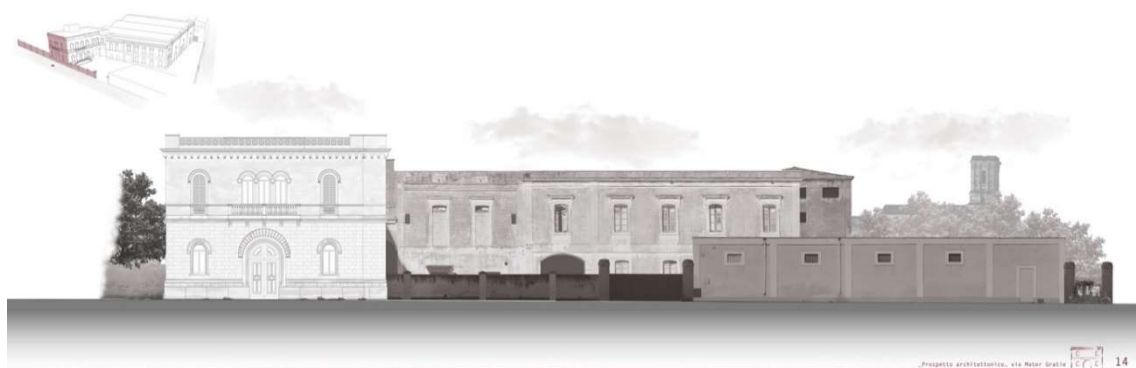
Squinzano. Complesso Folonari, prospetto meridionale (rilievi di G. Gubello, F. Guido, L. Imperiale).
